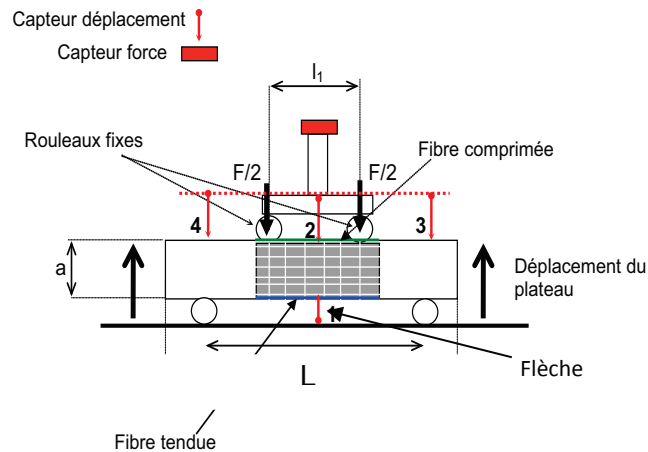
Schéma de la poutre de l'essai de flexion 4 points (Camp et al., 2010)
